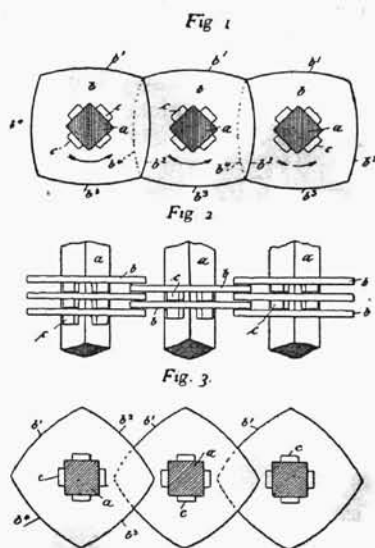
i 3 przedstawia widok z boku i przecięcie trzech belek, a rys. 2 plan ich położenia.
